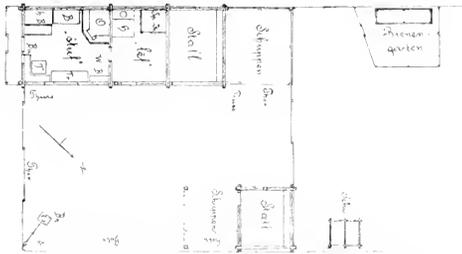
Grundriss zum Hause Nr. 75 in Deutsch-Budak. (1:400).
